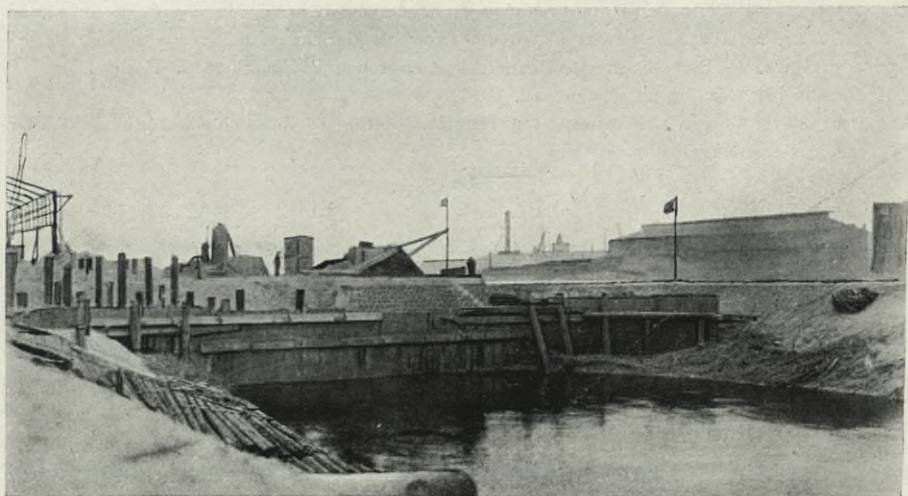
Costruzione d'un muro di banchina nel porto di Amsterdam.
